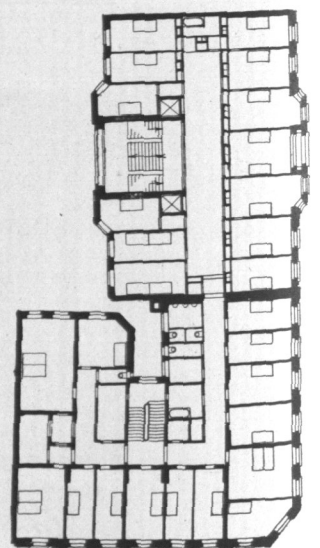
Hotel Berliner Hof, Obergeschoß, Grundriß.
